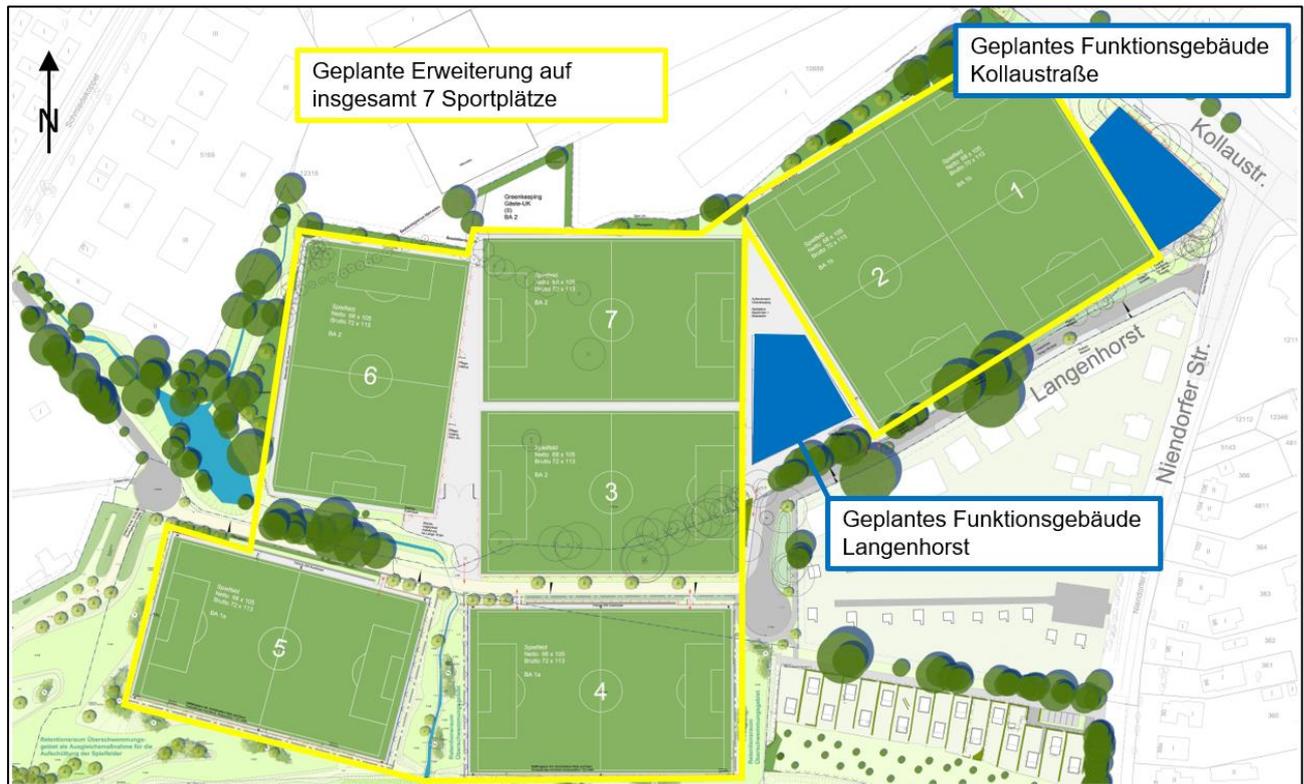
Übersichtslageplan Bauvorhaben (Plangrundlage: Munder und Erzepky Landschaftsarchitekten bdla)
